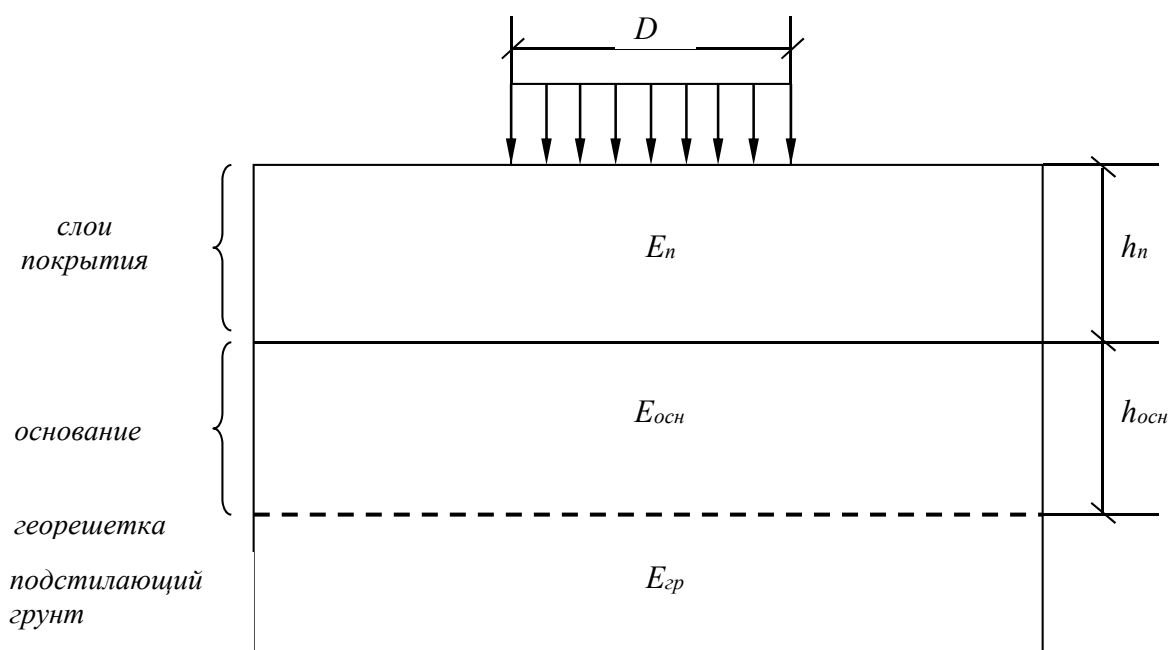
Расчетная схема дорожных одежд капитального и облегченного типов, армированных георешеткой серии ТХ
